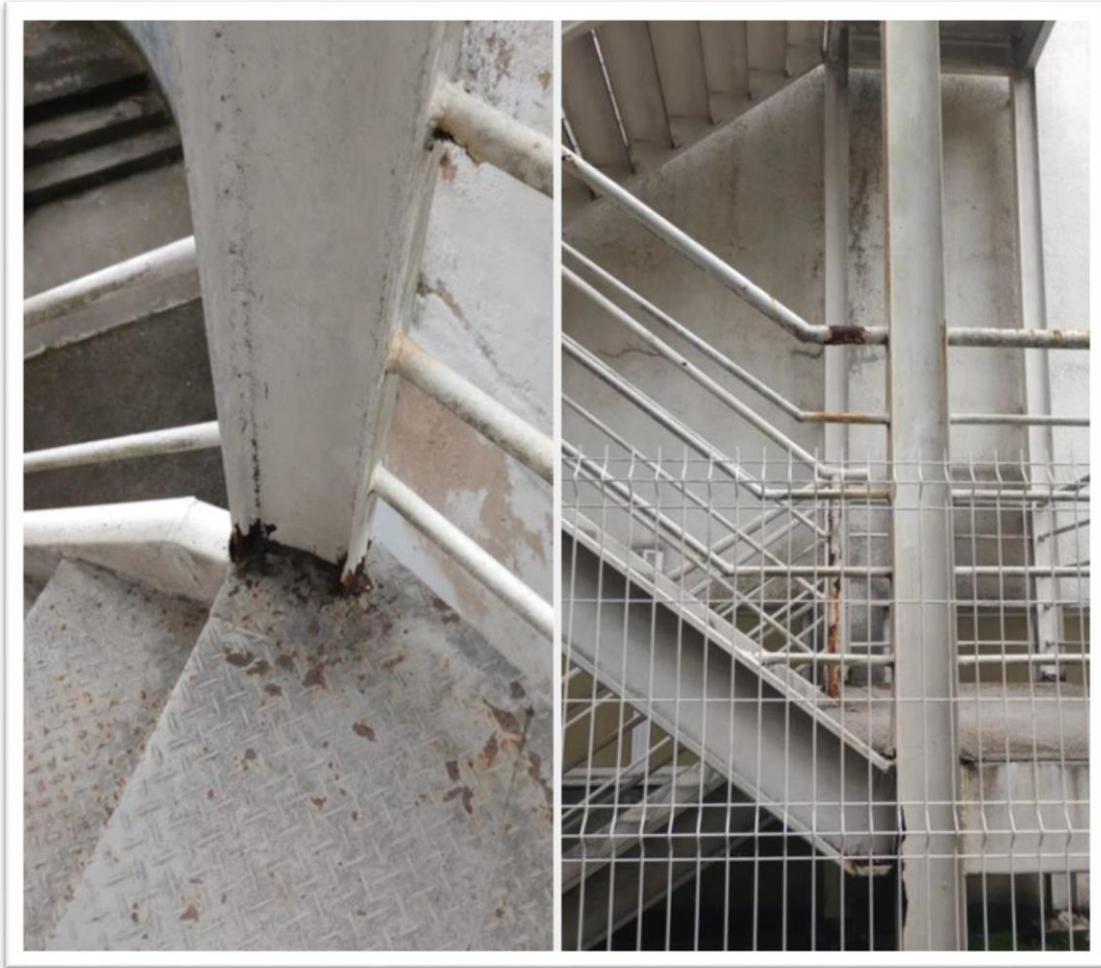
e 36 – A estrutura metálica encontra-se oxidada, os perfis precisam de recuperação e tratamento.
